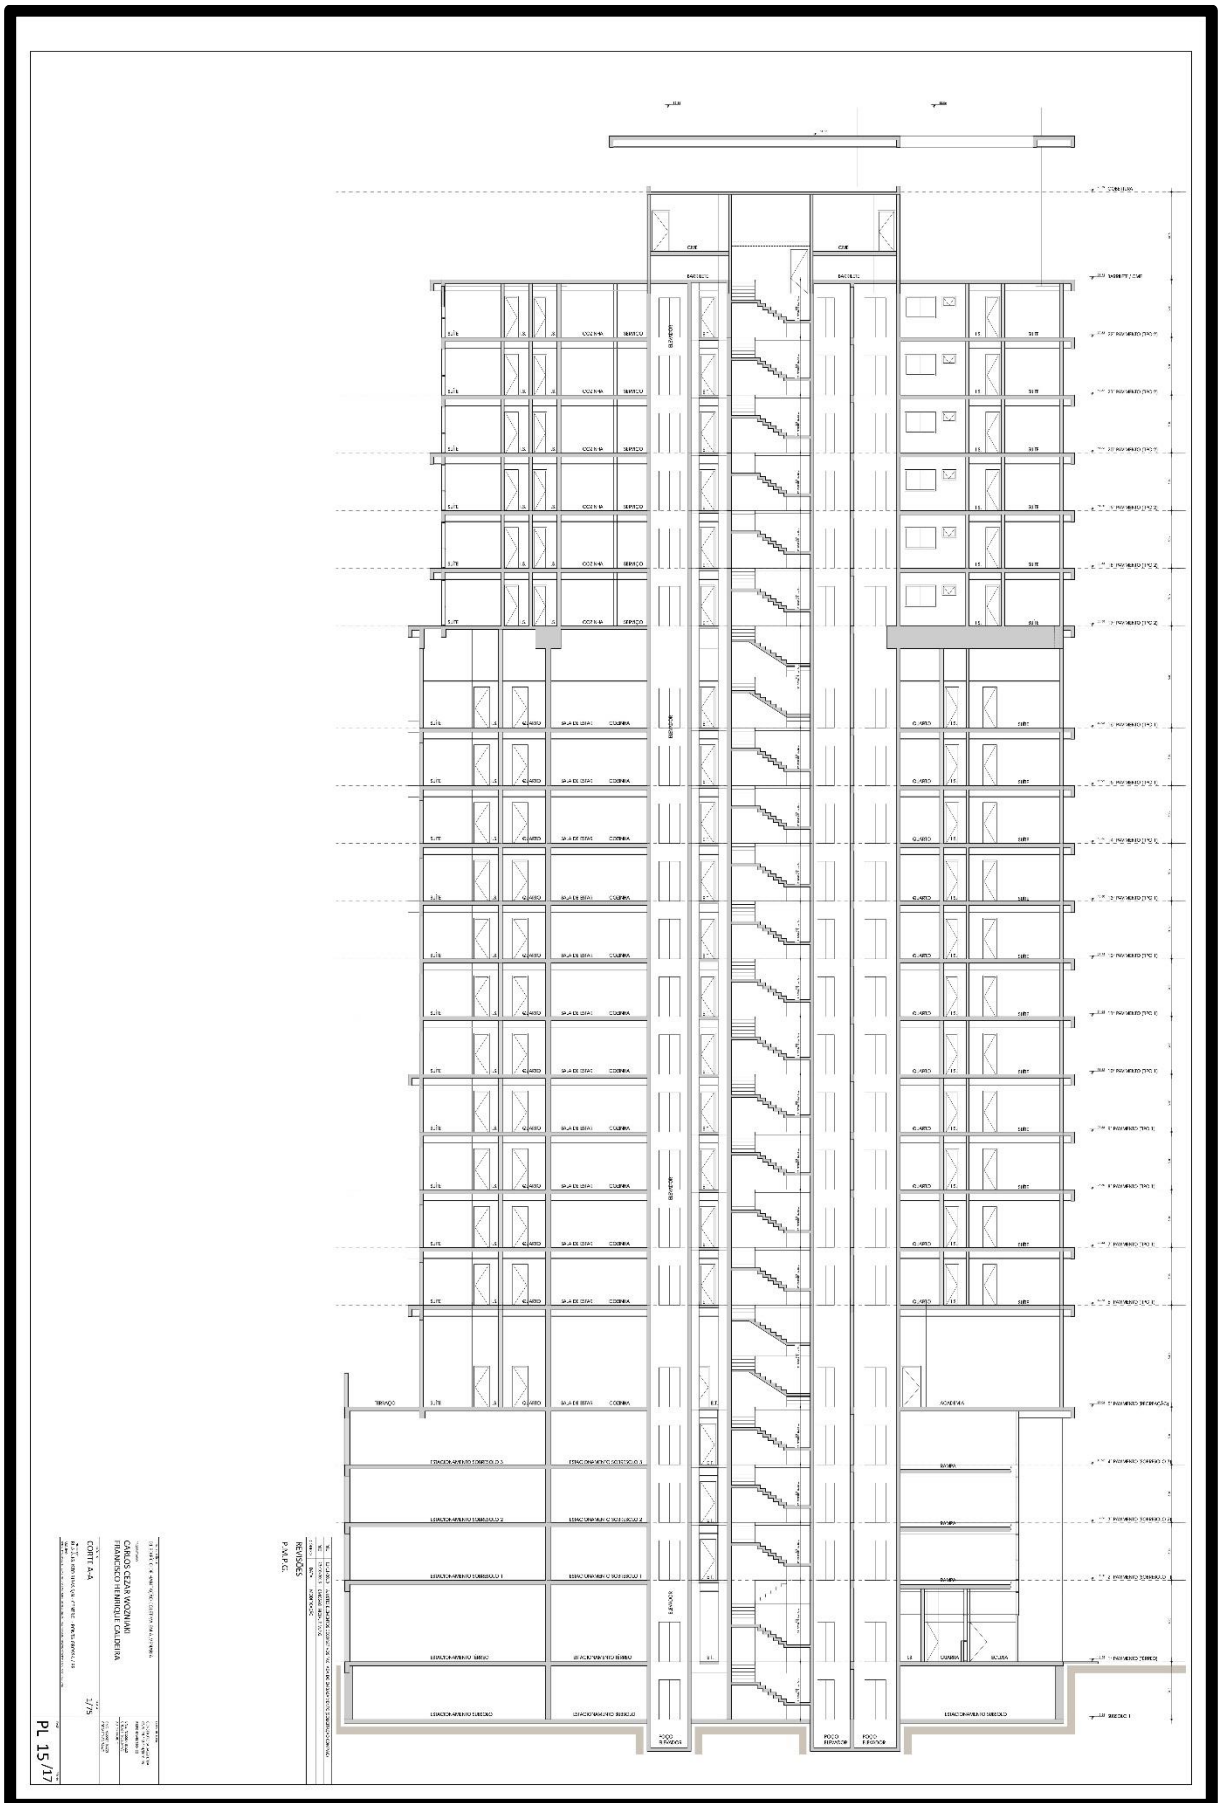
Corte A. Fonte: Construtora Bazzi (2020).
